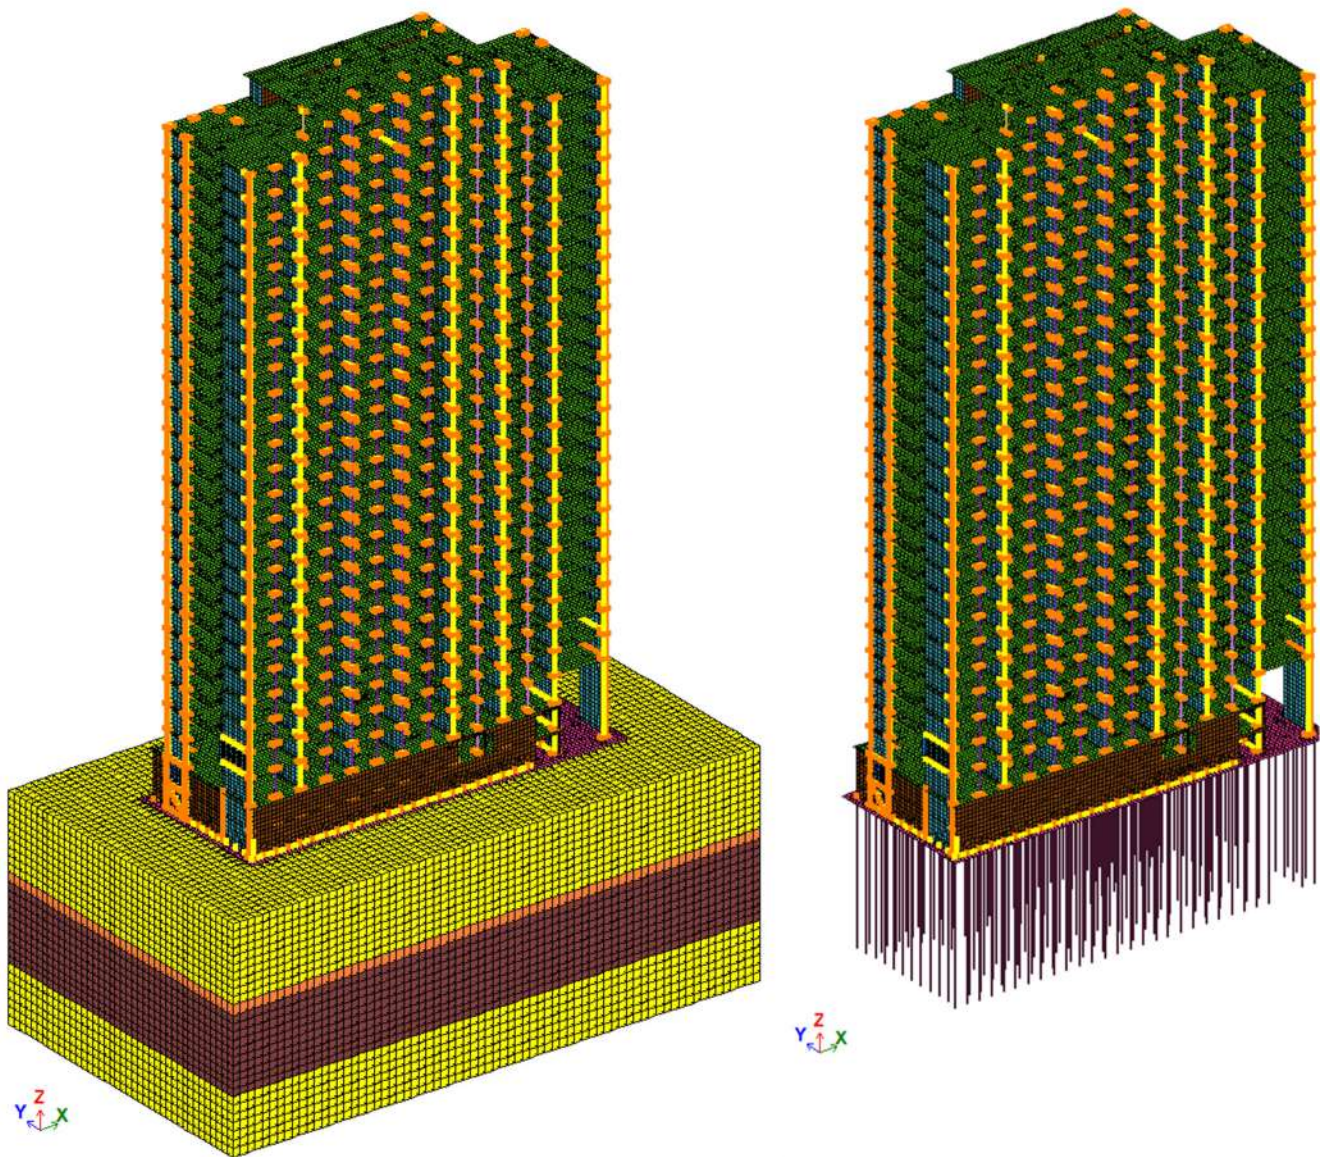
Модель будівлі з прив'язкою до об'ємного ґрунтового масиву
